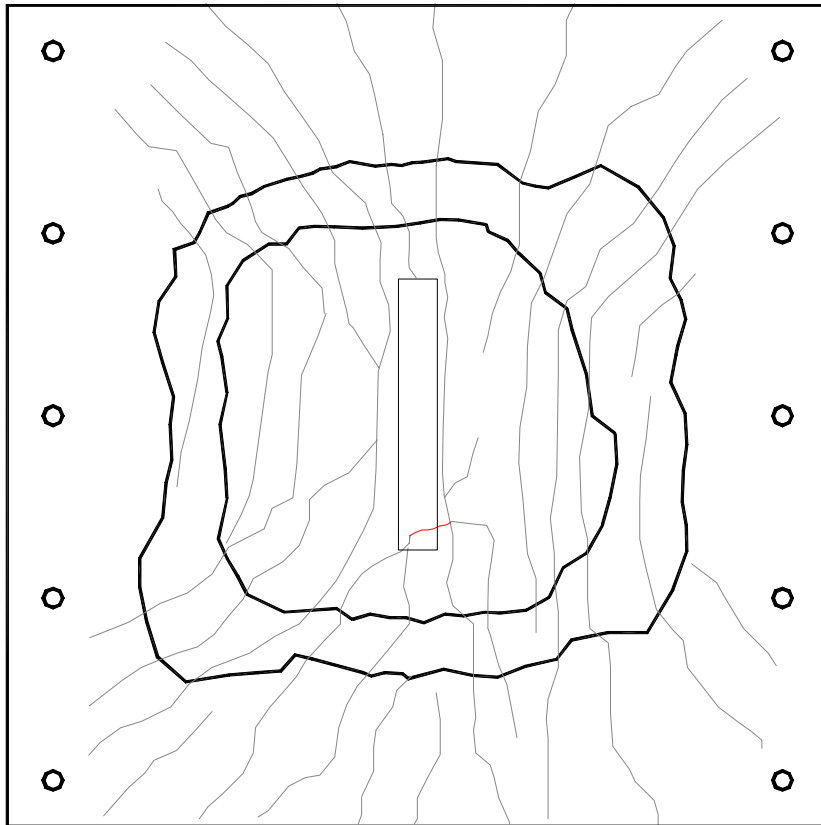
Mapa de fissuração da laje L4B
